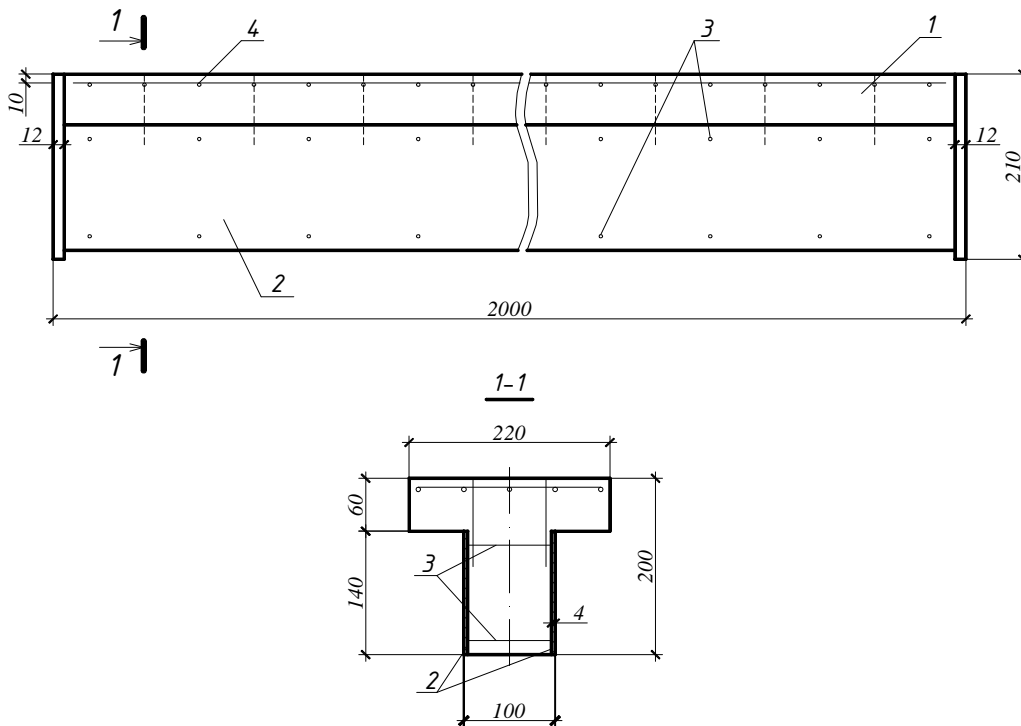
Поперечний переріз таврової сталезалізобетонної балки зі стрічковим армуванням: 1 – залізобетонна складові таврового перерізу; 2 – сталеві стрічкові листи; 3 – арматурні хомути; 4 – арматурна сітка
